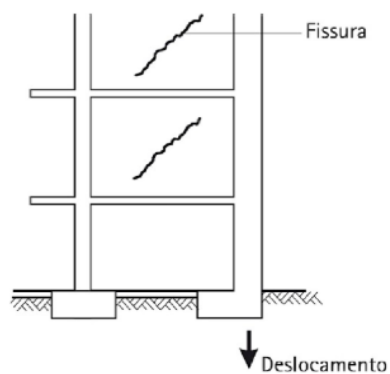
Fissuras causadas por recalque de fundações no pilar dos cantos (Fonte: Ortiz, 1984)
